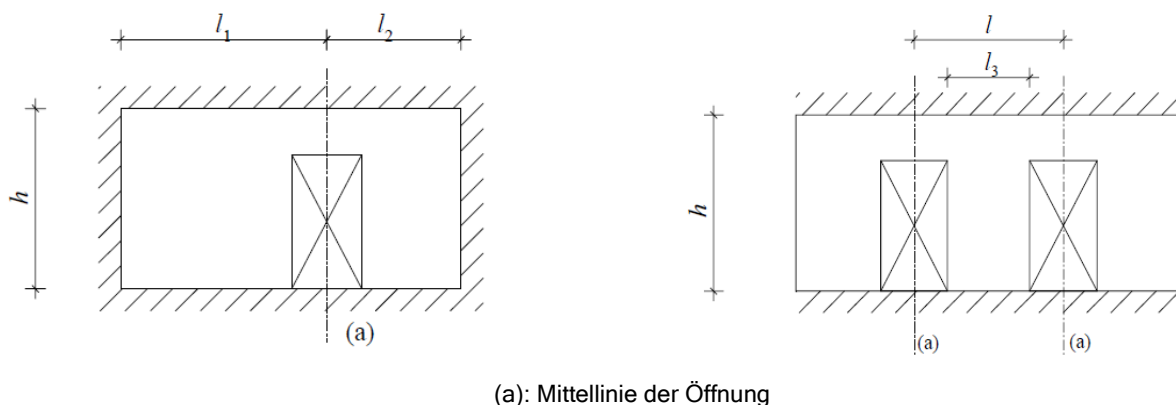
Wand mit einer Öffnung: links: Typ a rechts: Typ d
